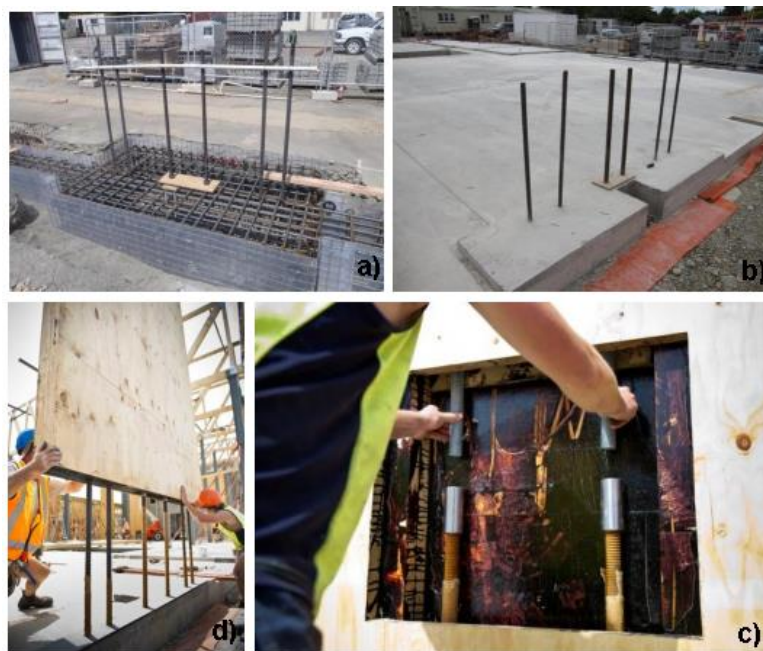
Processo construtivo de uma parede pré-esforçada: a) fundações da parede; b) extremidades dos cabos de pré-esforço e dissipadores rebocados às fundações; c) ligação dos cabos de pré-esforço Macalloy e d) colocação em obra do painel LVL (Palermo *et al.*, 2012).
